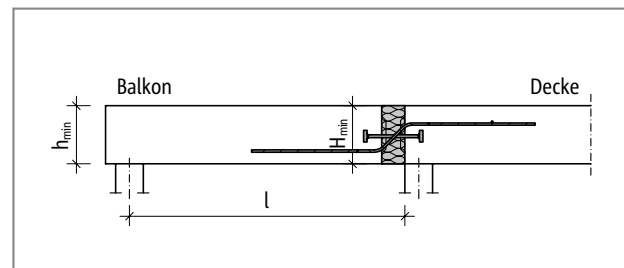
Schöck Isokorb® Typ QP80L: Statisches System
